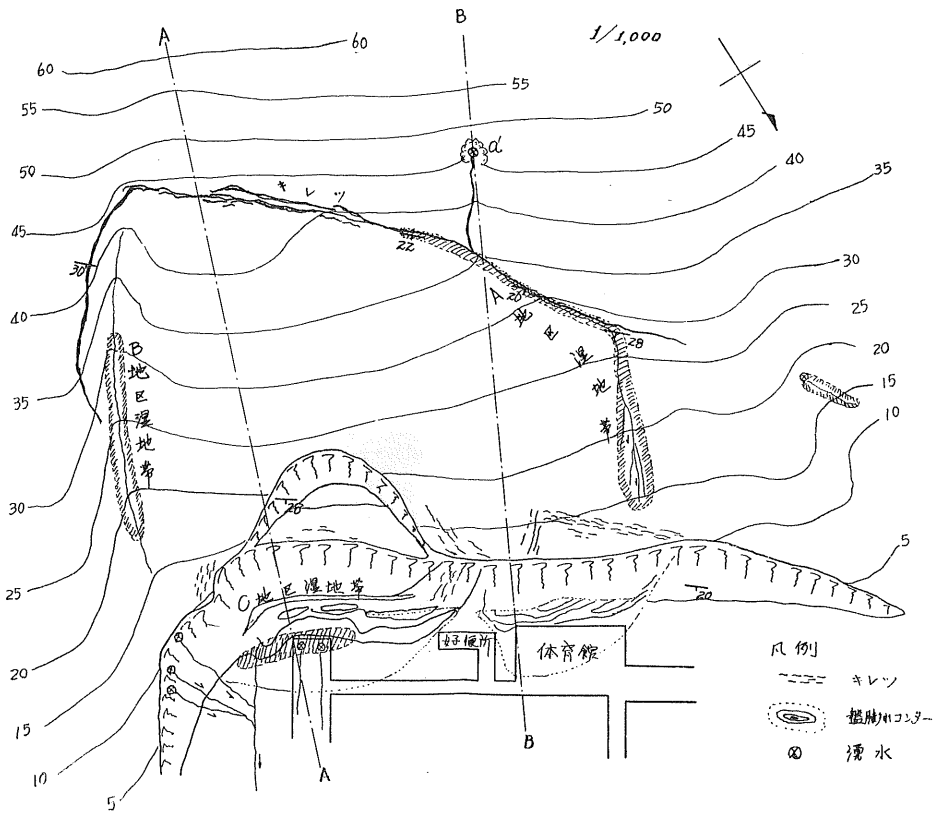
歌志内中央小学校裏山地り地帯平面図(第2次地り)
